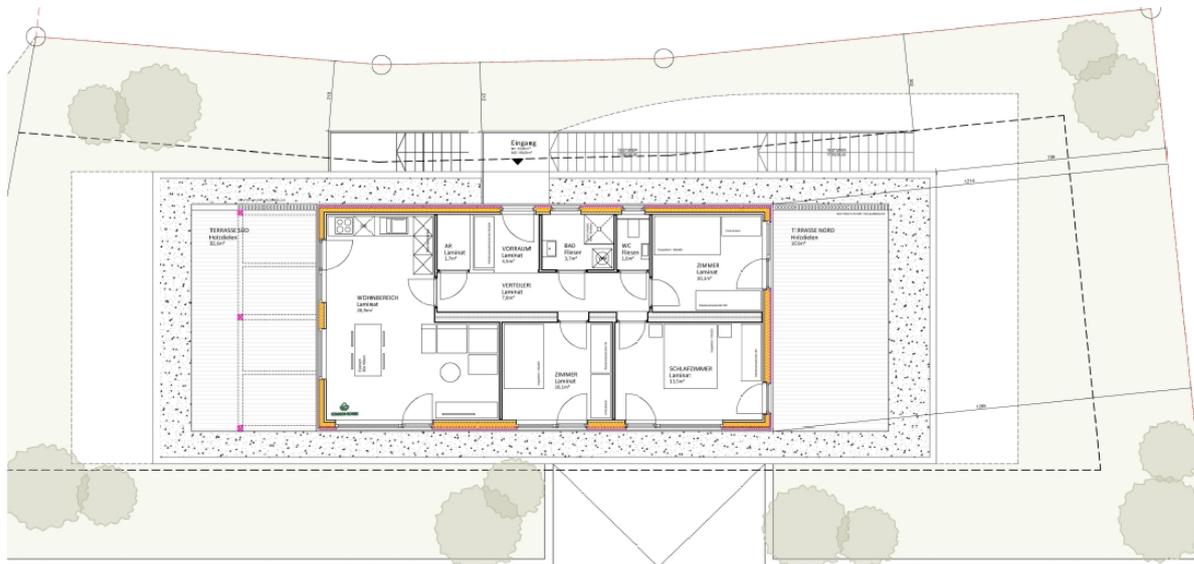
Grundriss DG, COMMOD HOUSE vom 13.08.2021
